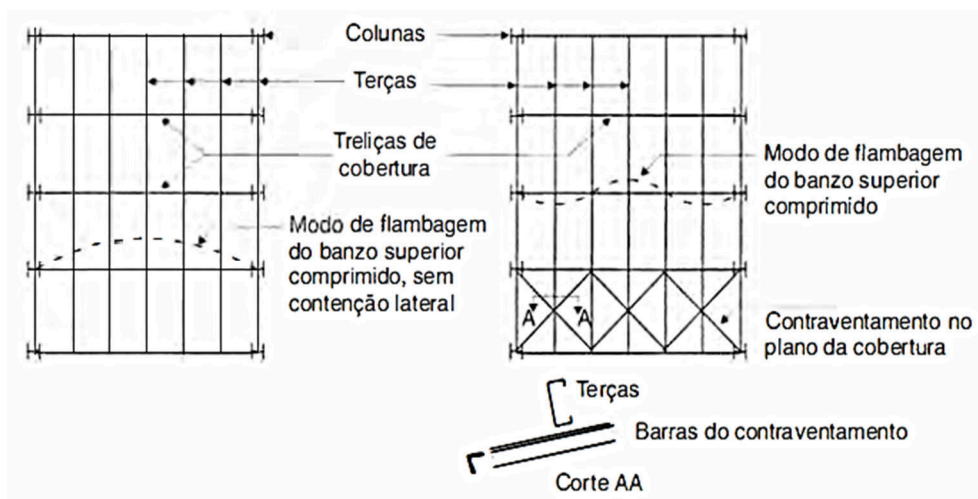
Sistema portante principal de um galpão metálico.
